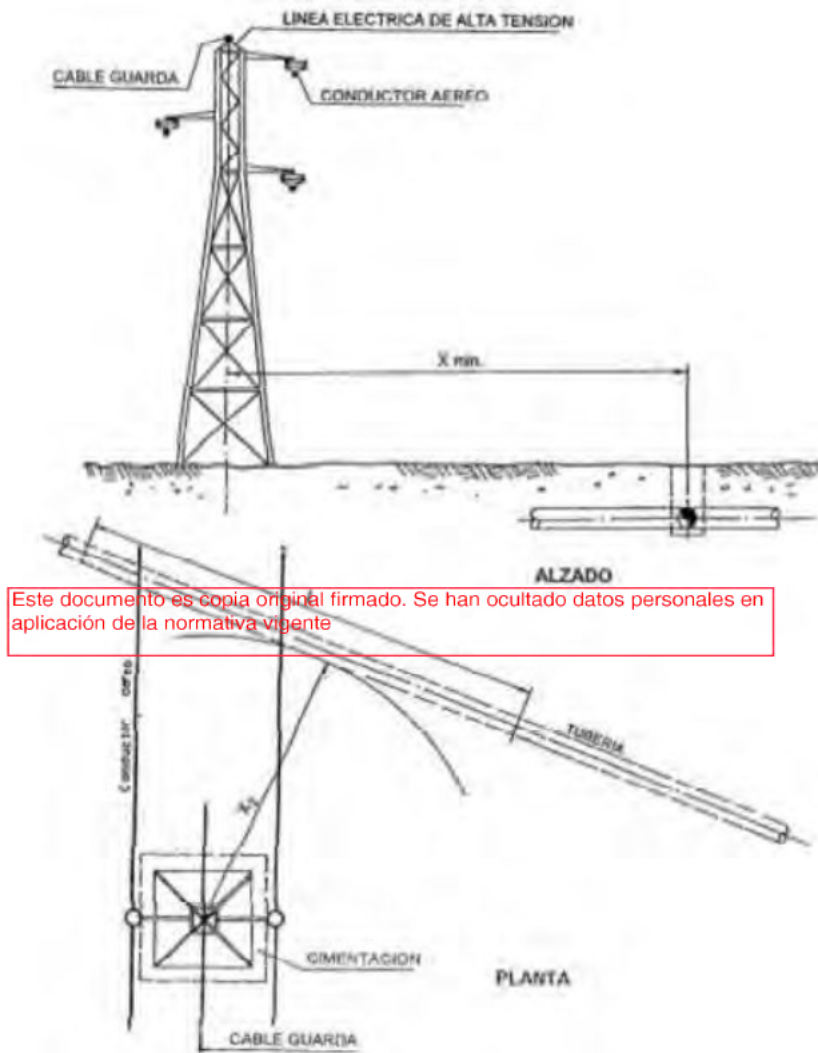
Disposición relativa en planta y alzado entre el apoyo y la tubería
